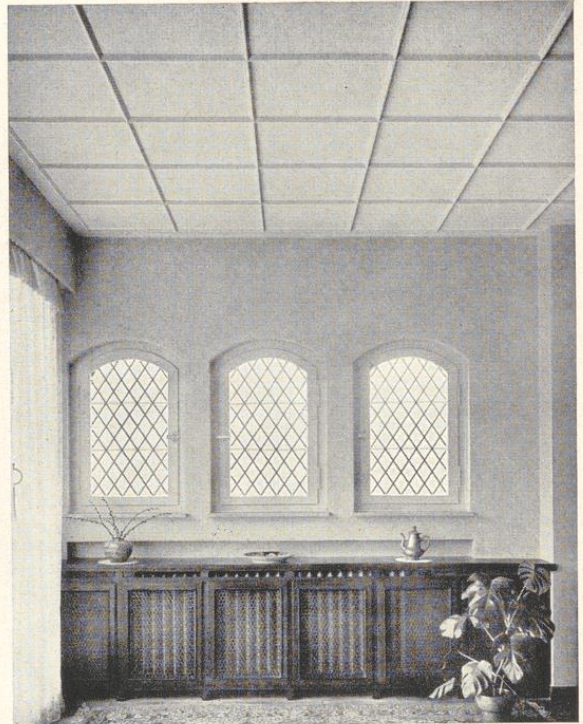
Stuckdecke in der Vorhalle eines Landhauses. Ausführung Stuckgeschäft J. Odenthal, Düsseldorf-Gerresheim
